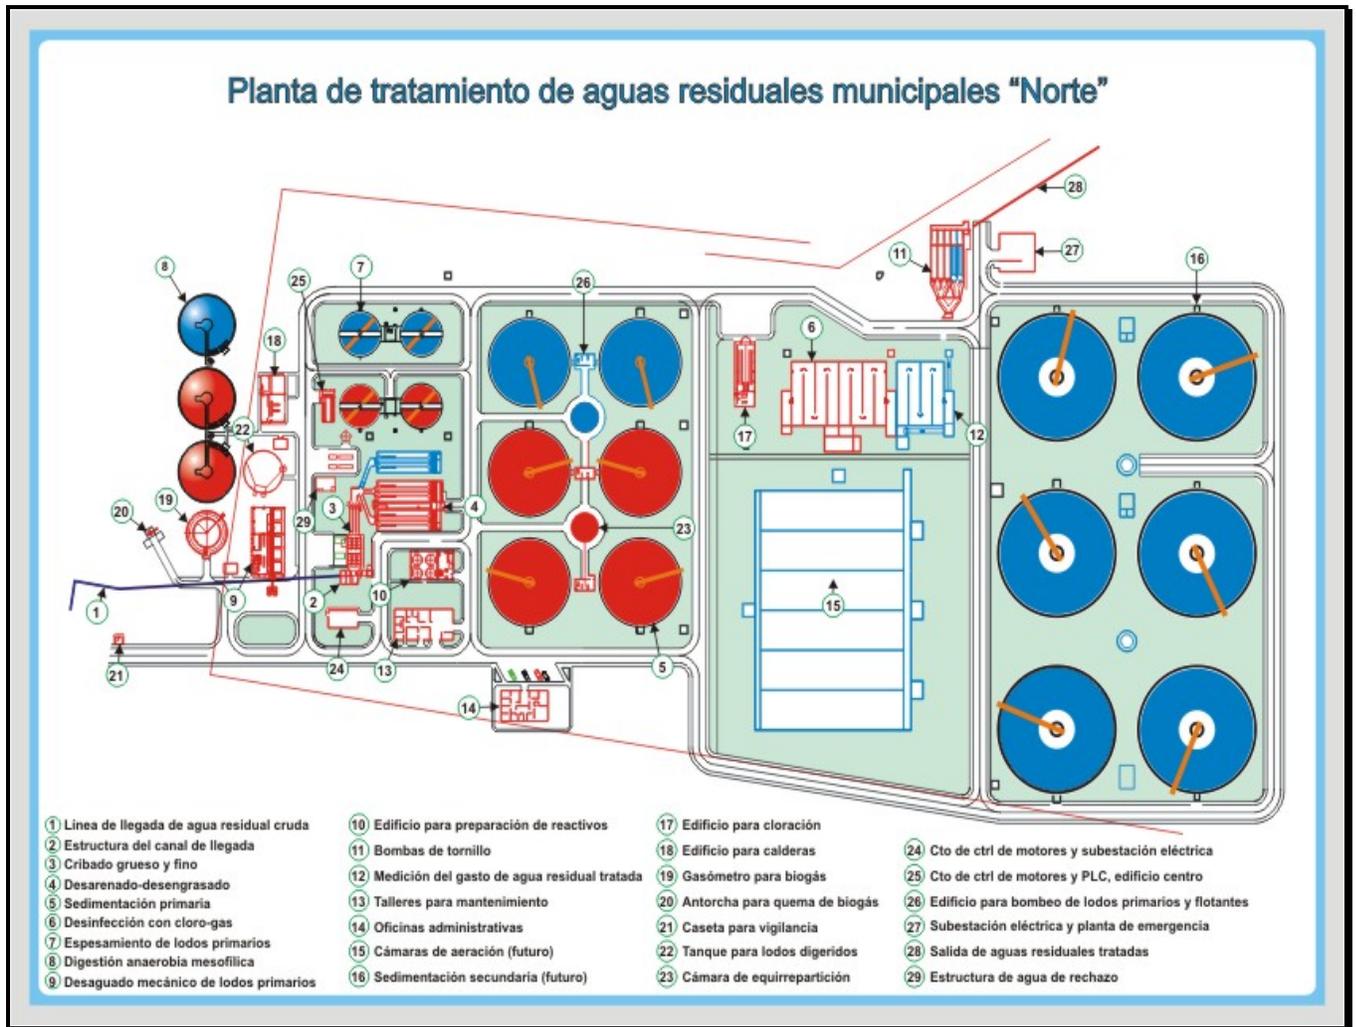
Plano de arreglo de conjunto de la Planta Norte (JAPAC, 2006)
